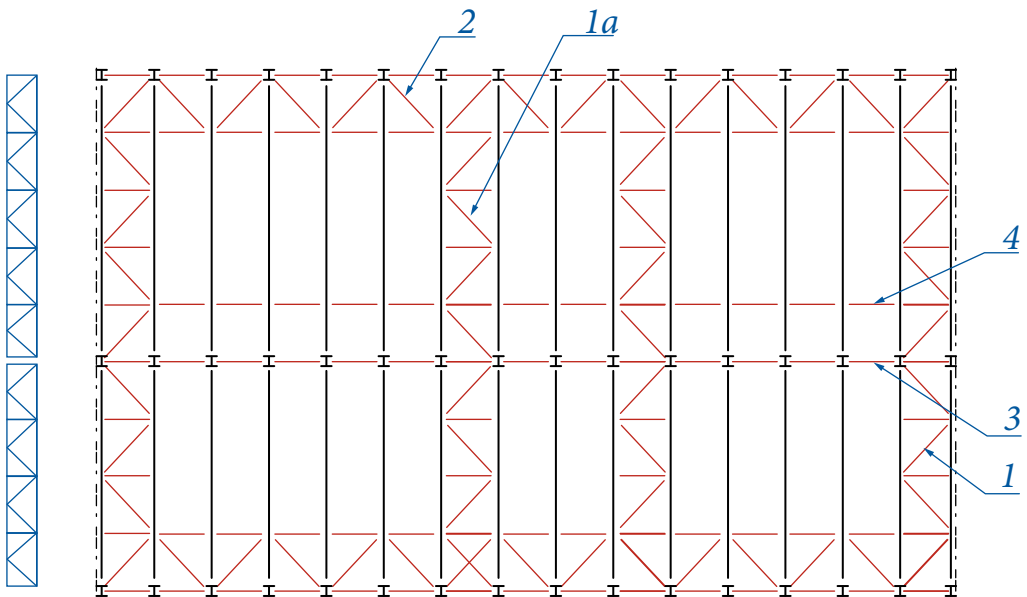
Схема горизонтальных связей по нижним поясам ферм:
